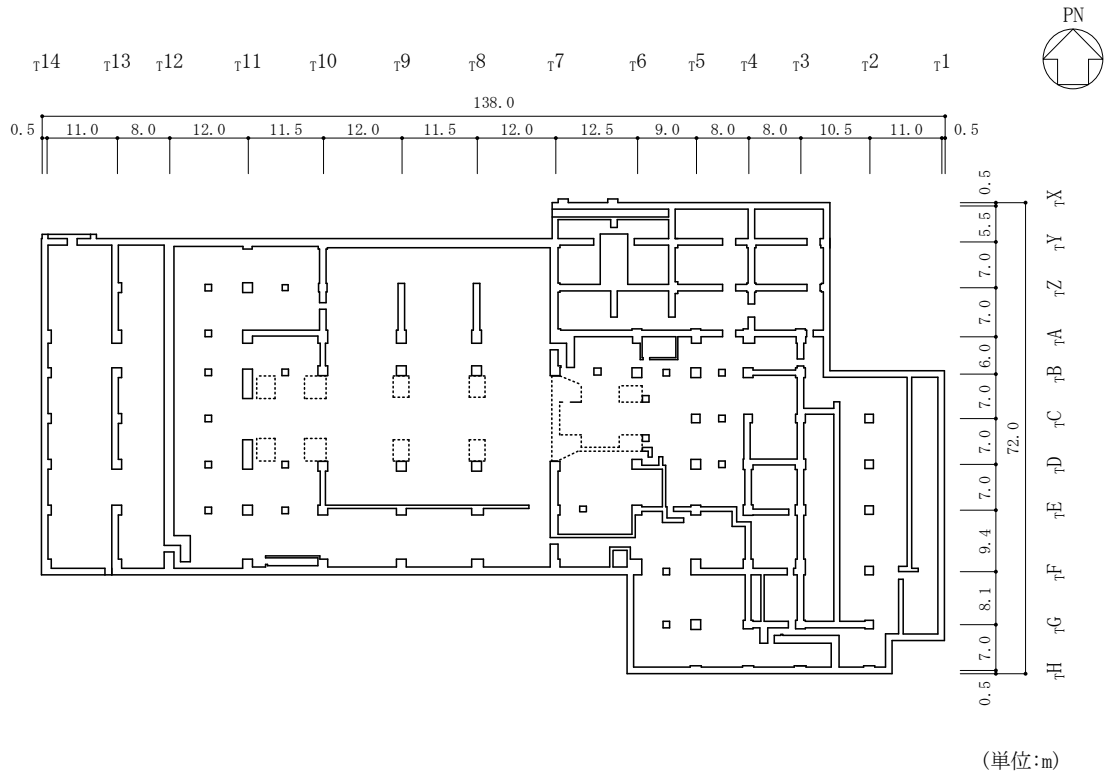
(1) タービン建物の概略平面図 (EL 2.0m\*)
